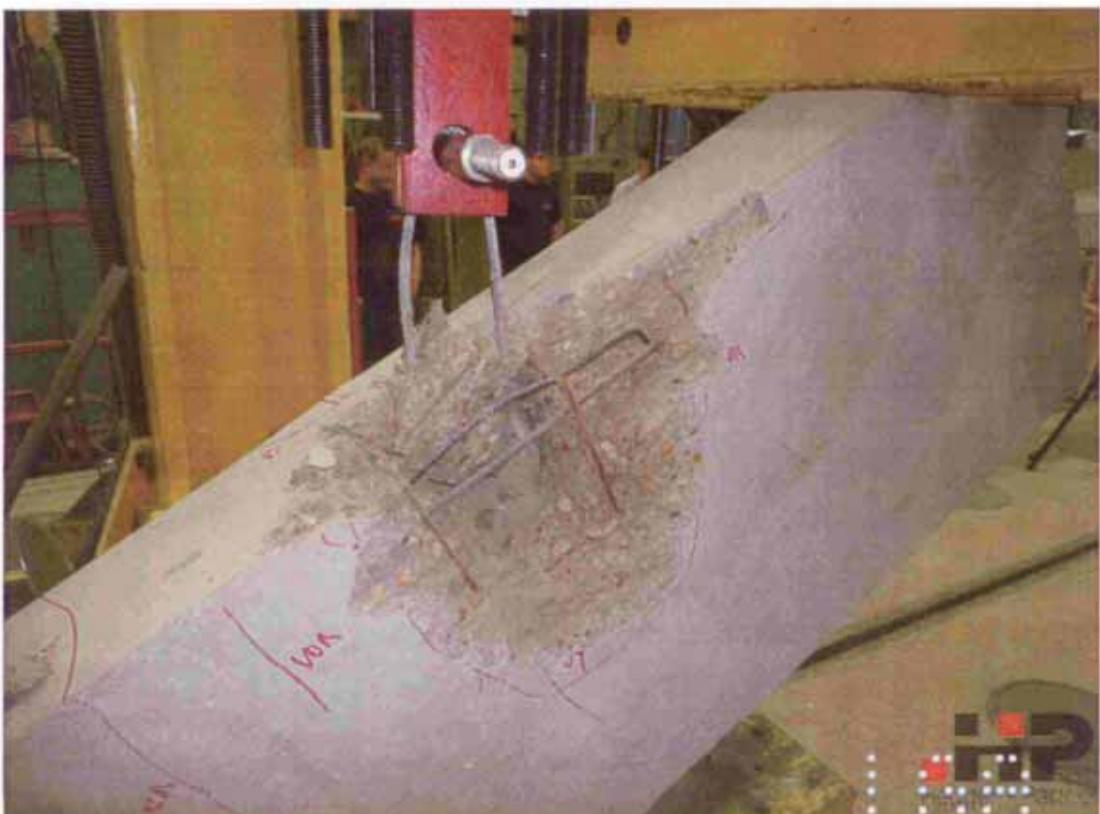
Betonausbruchdetail mit verbogener Zulagebewehrung
